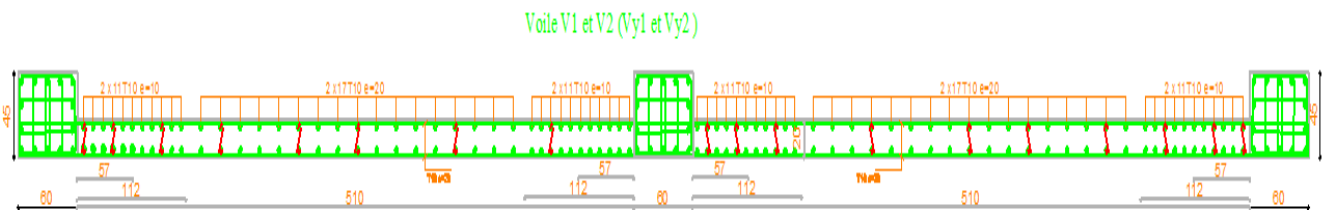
Schéma de Ferrailage Vy1.Vy2
